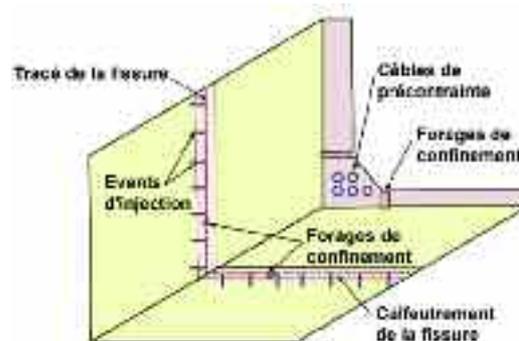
principe de calfoutement des fissures et de confinement des zones à injecter
